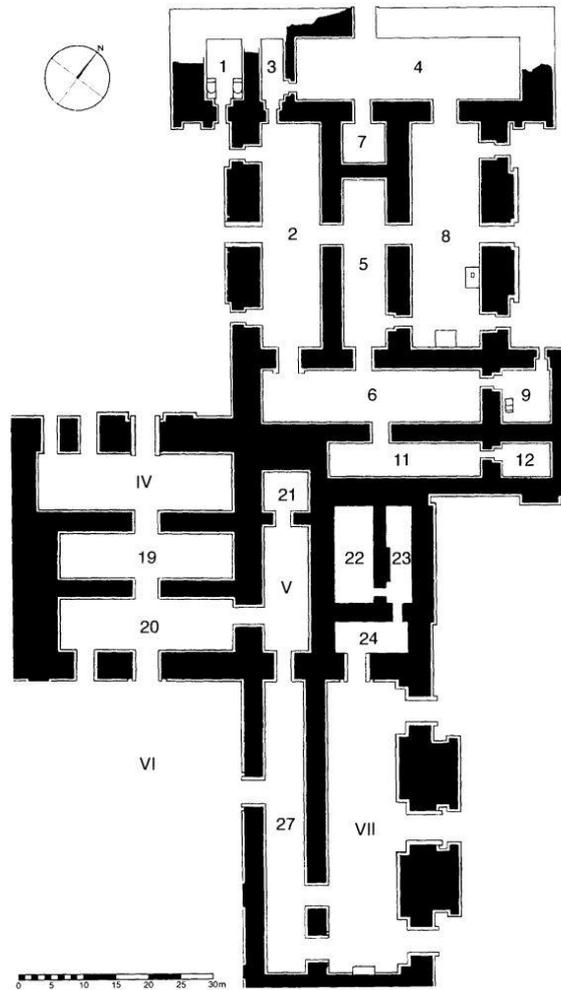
Detalhe da planta do Palácio de Sargon II.
